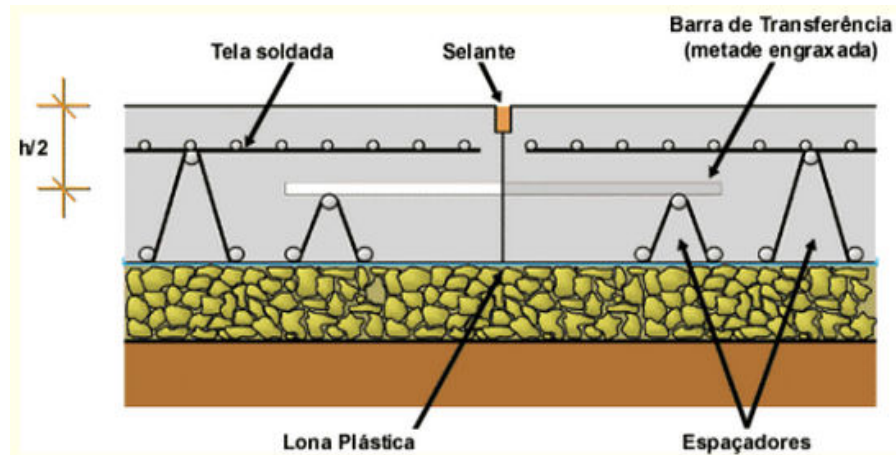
Detalhe de uma junta de construção feita com barras de transferência.
